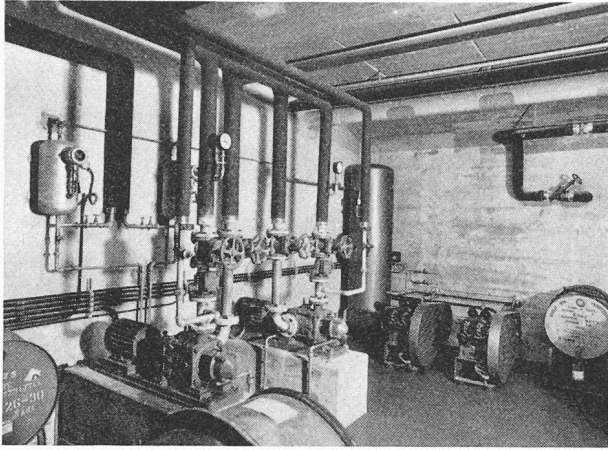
Vue du groupe de surpression lavage et de la centrale air comprimé.
